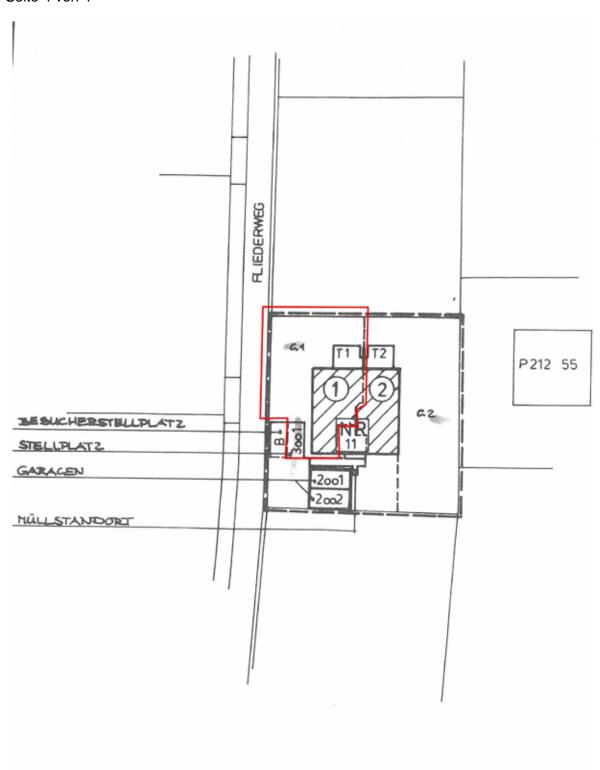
Lageplan (mit Kennzeichnung der Lage des Sondereigentums und der zugehörigen Sondernutzungsrechte)
